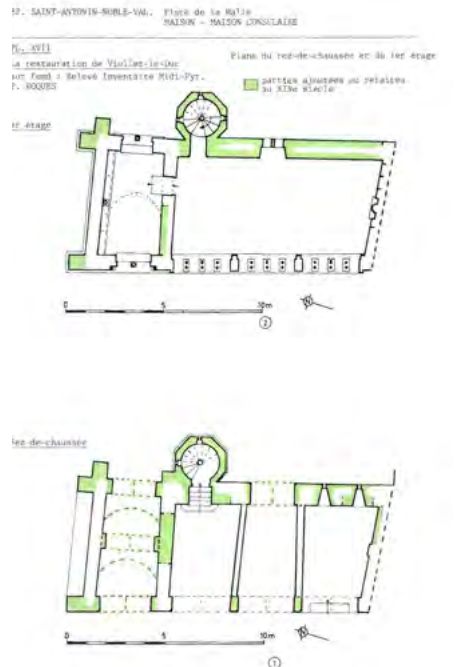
? Plans de Viollet-le-Duc (source: Inventaire)
